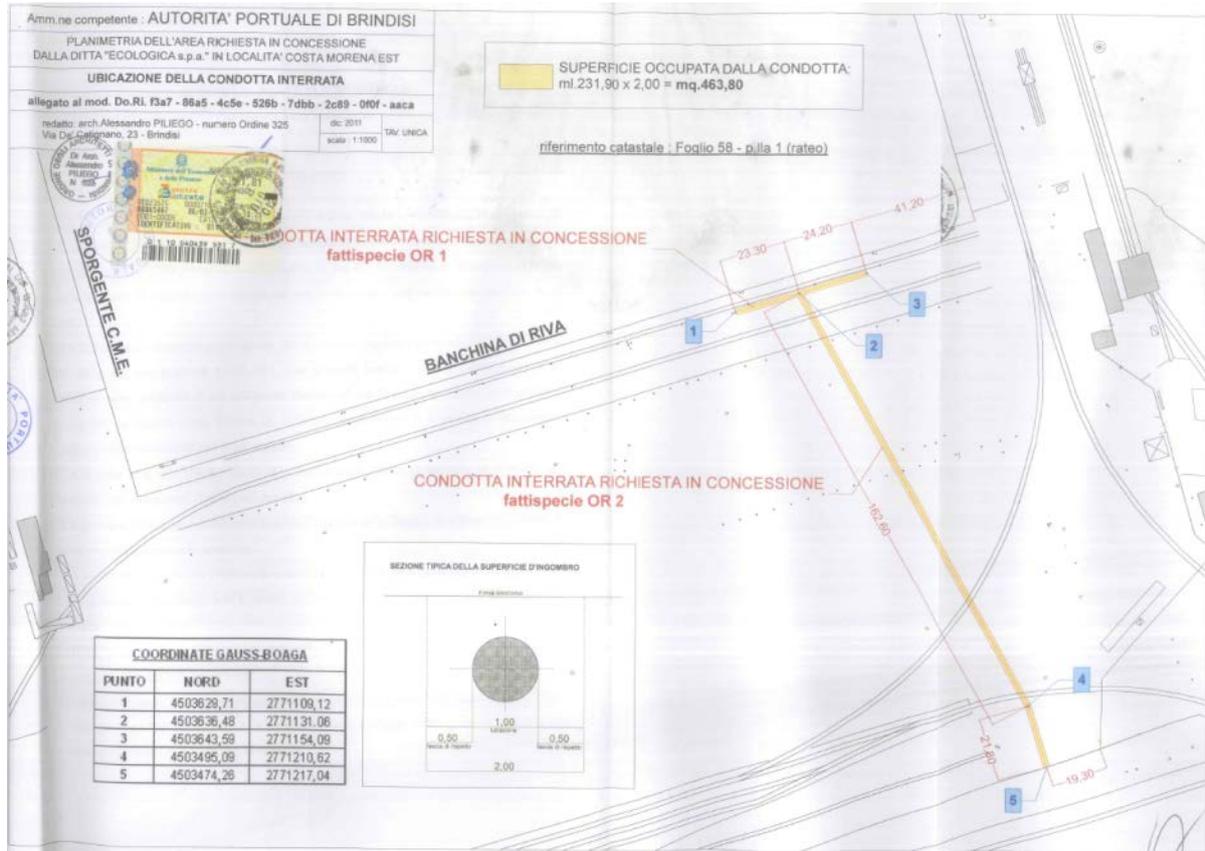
STRALCIO PLANIMETRICO CONDOTTA IN AREA DEMANIALE
